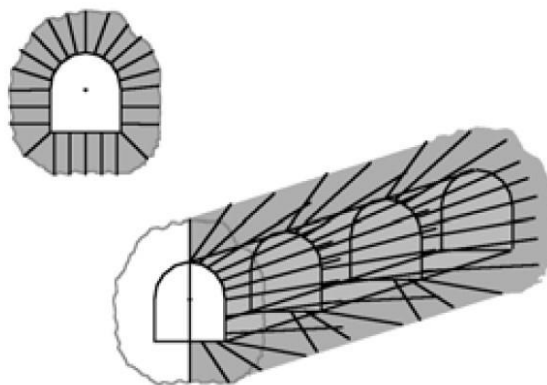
Exemplo da área de aplicação de grouting em redor da secção do túnel (Grøv, *Introduction to water control in Norwegian tunnelling*, 2014).
